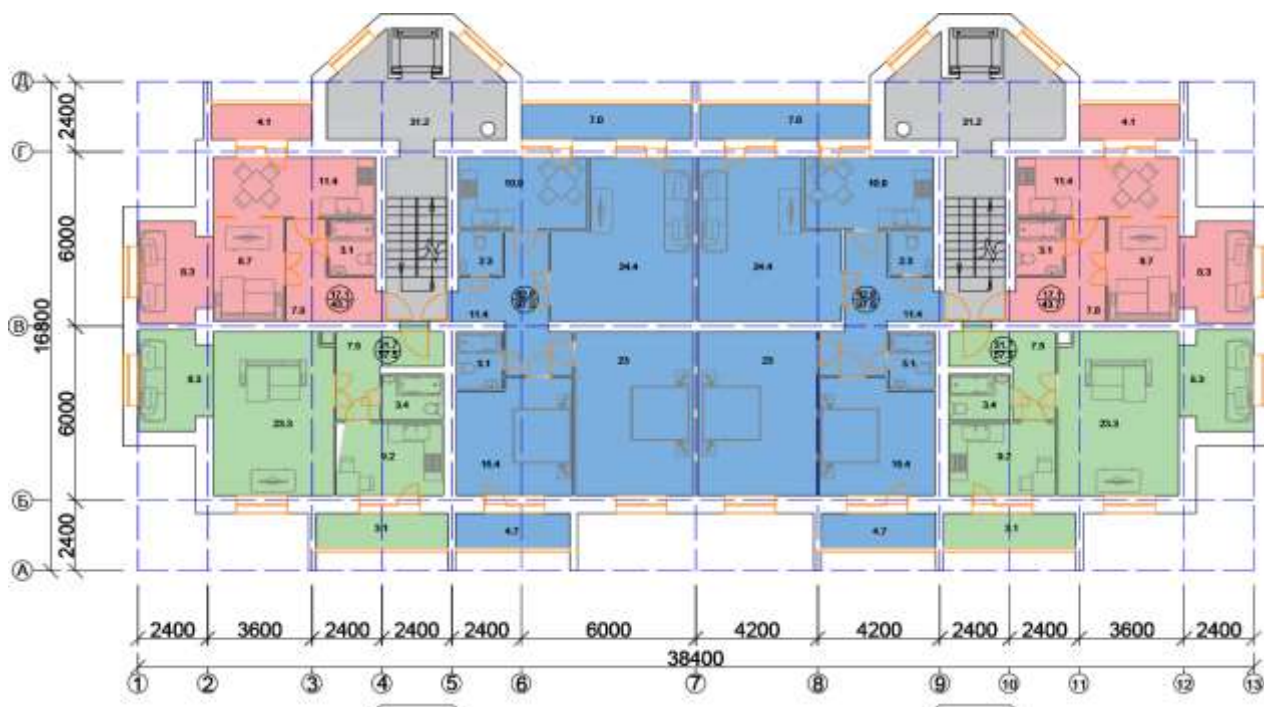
План 2-5-го этажей 1-1-3-1-1-3. Второй вариант реконструкции серии 1-447
